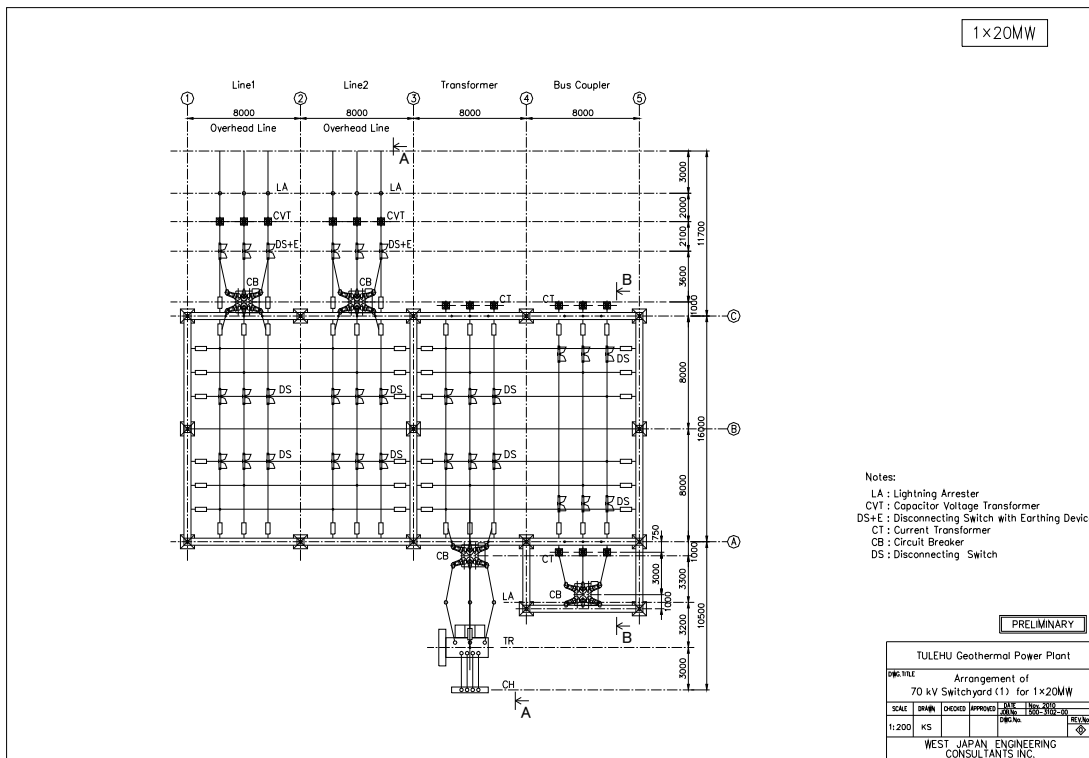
70kV 開閉所平面図 (20MW×1)
